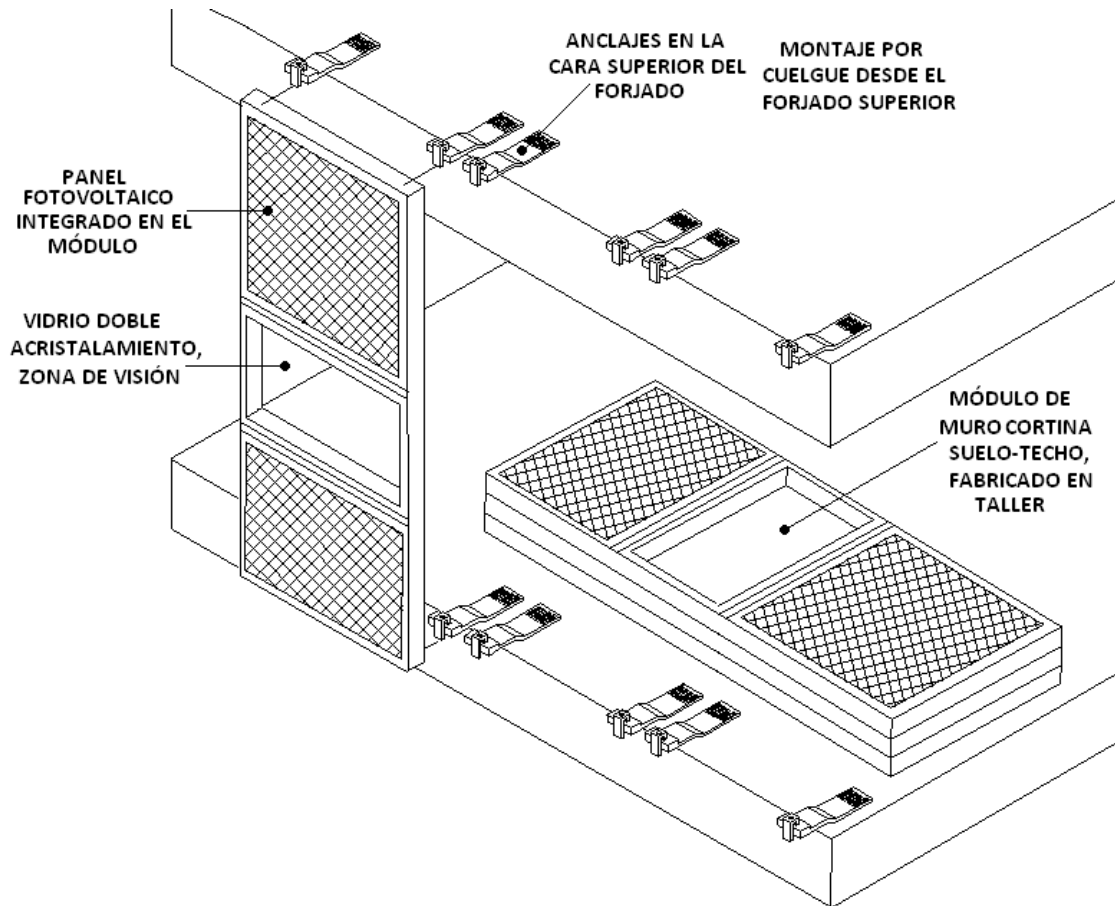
Esquema del proceso de montaje de un muro cortina modular: se avanza de un lado a otro de la planta y de abajo a arriba por la fachada.
